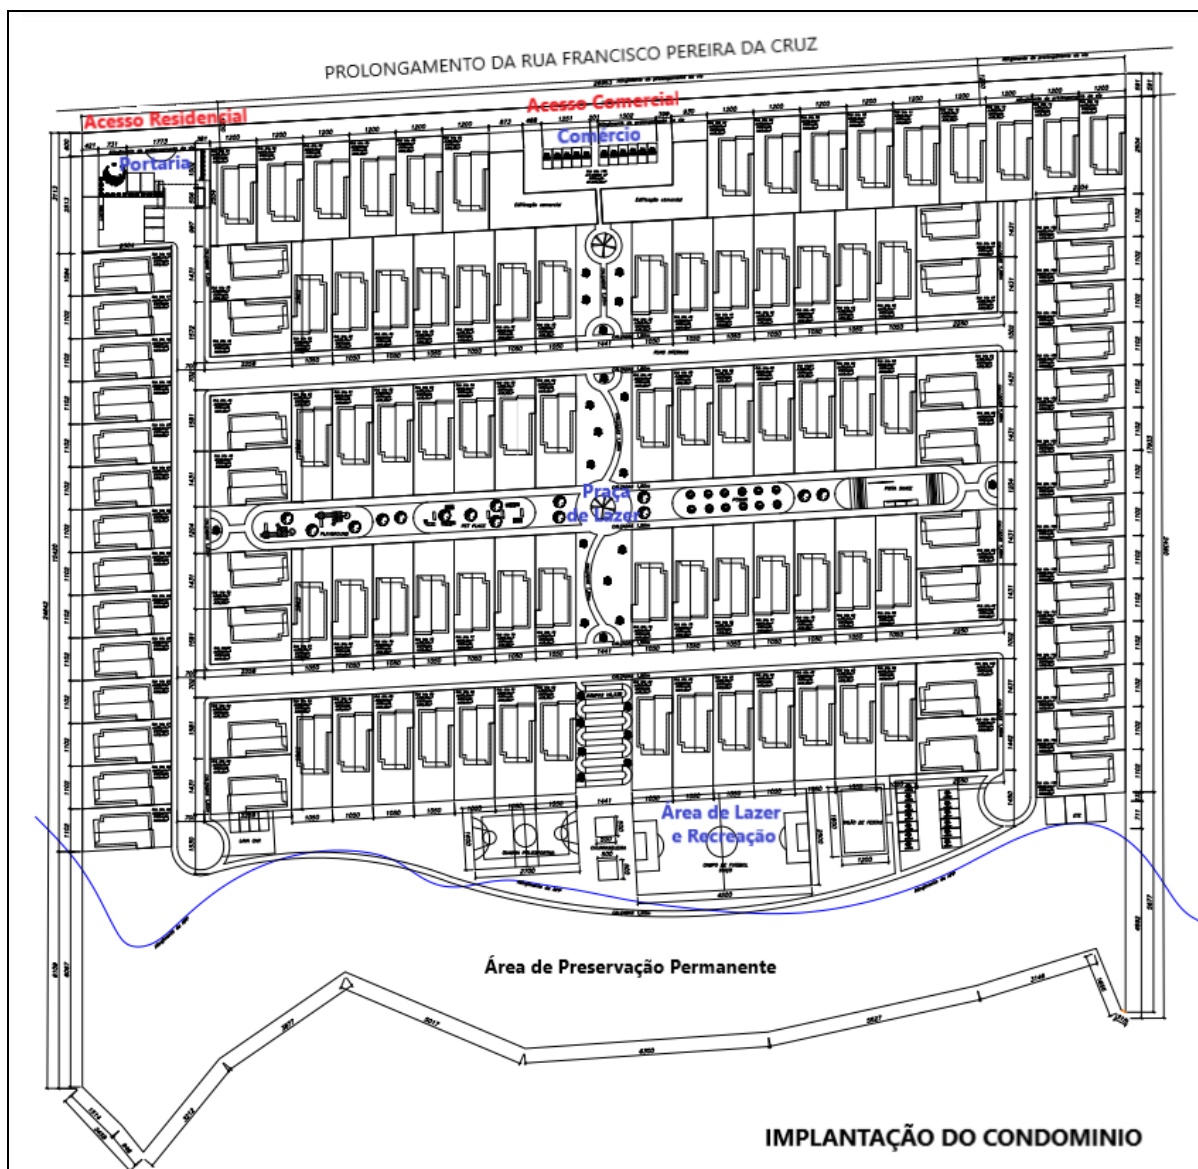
Croqui de implantação do Condomínio e as edificações a serem construídas.
